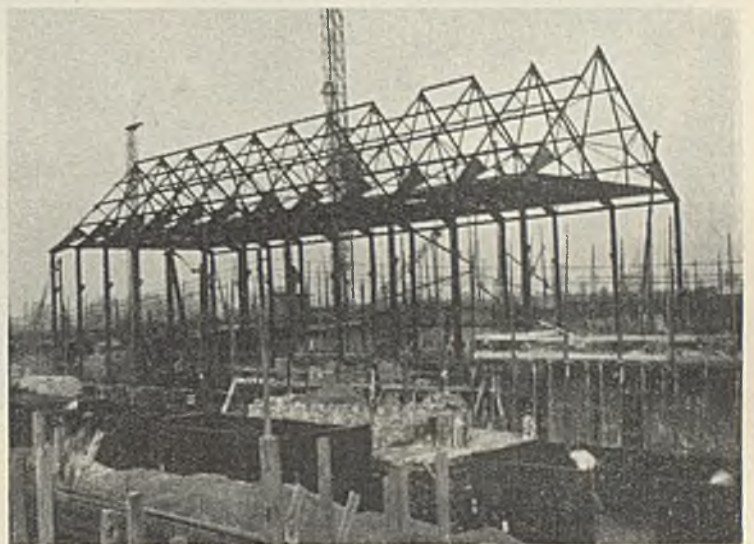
Eisenkonstruktion des Maschinenhauses.
